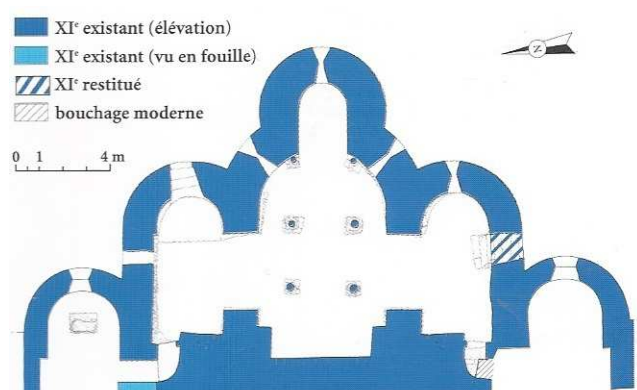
Crypte de la prieurale d'Anzy-le-Duc
